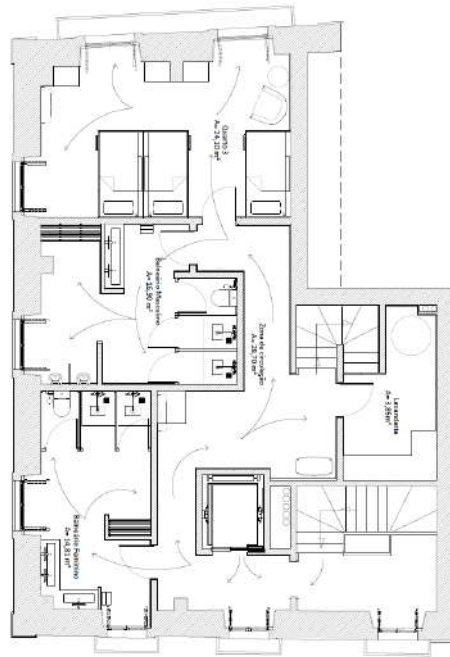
Planta de Zonamento e Circulação - Piso 2
